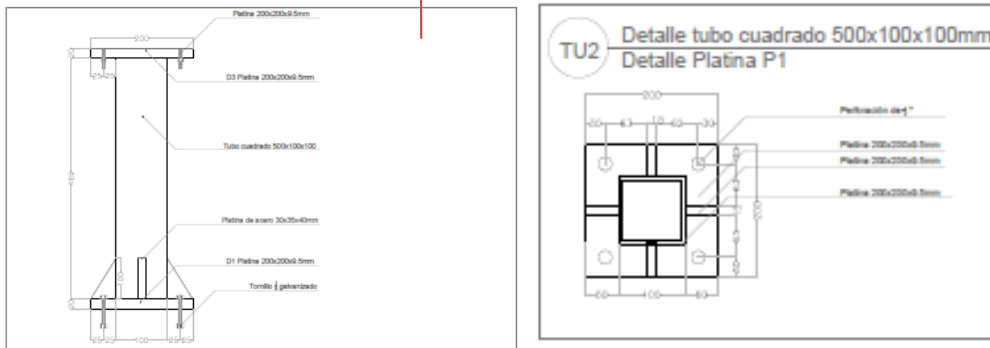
Soporte metálico estructura propuesta. Elaboración propia.
